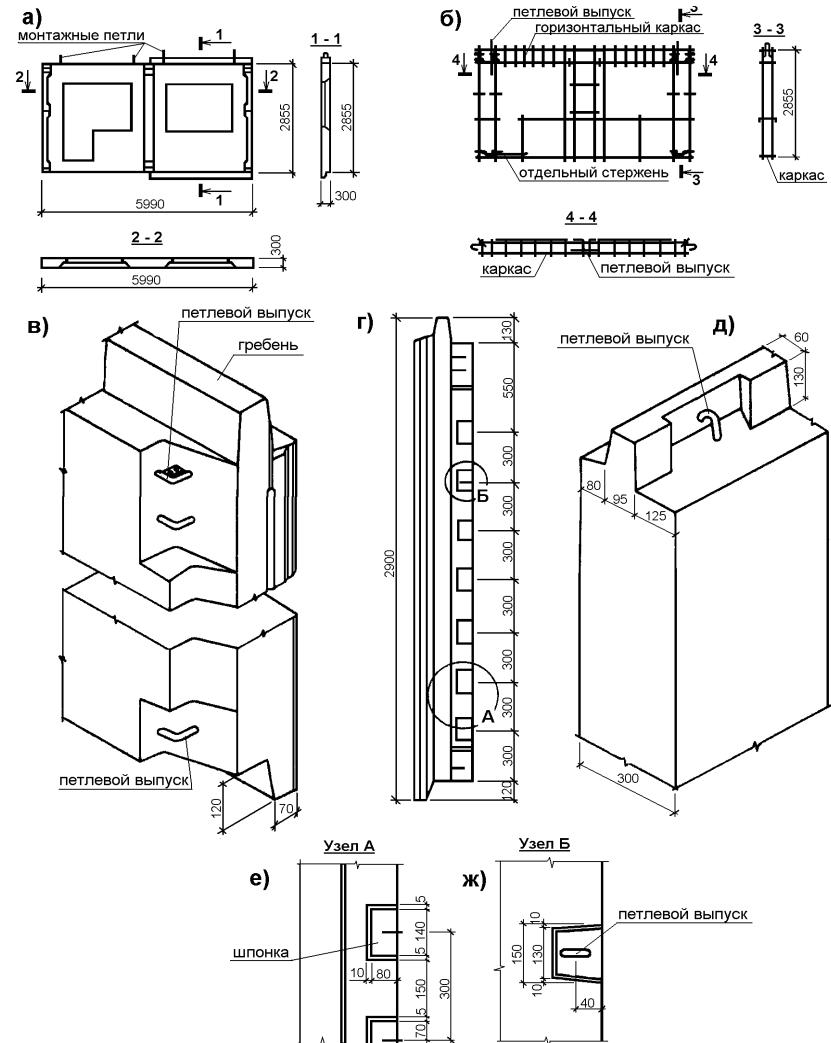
Рядовая легкобетонная однослоистая панель наружной стены.
